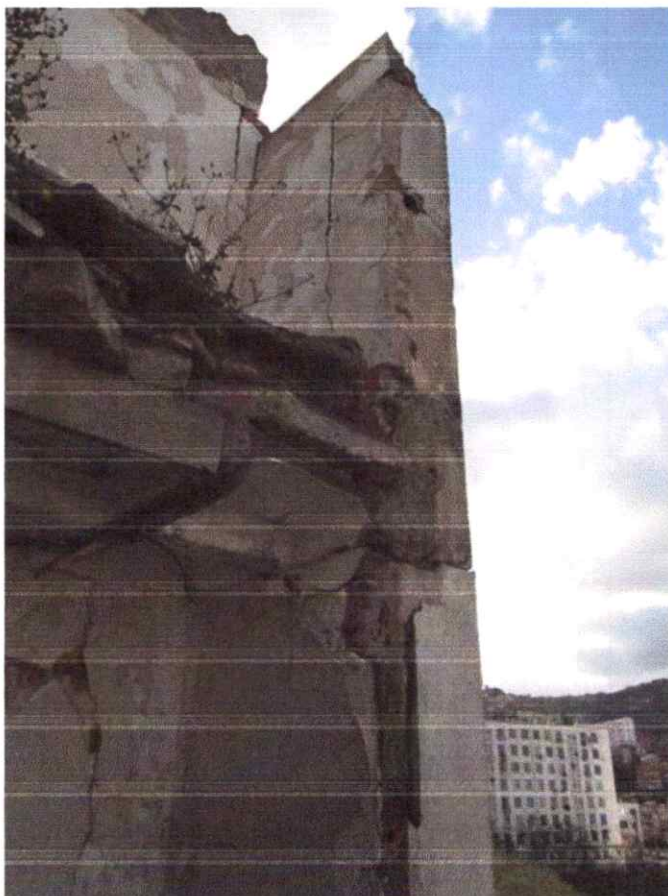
fissure laissant apparaître les murs et le plancher
